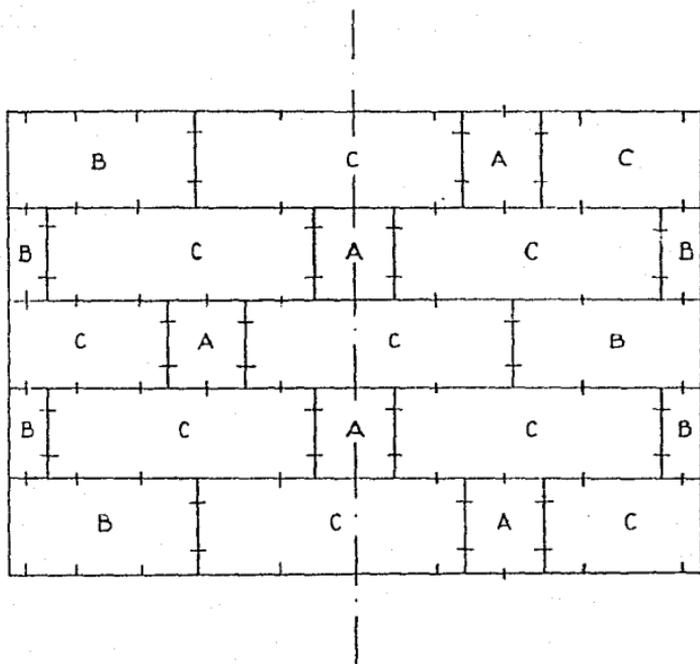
PLANTA ESQUEMATICA DE LA COLOCACION Y DETALLES DE UNION DE LOS ANILLOS DE DOVELAS
